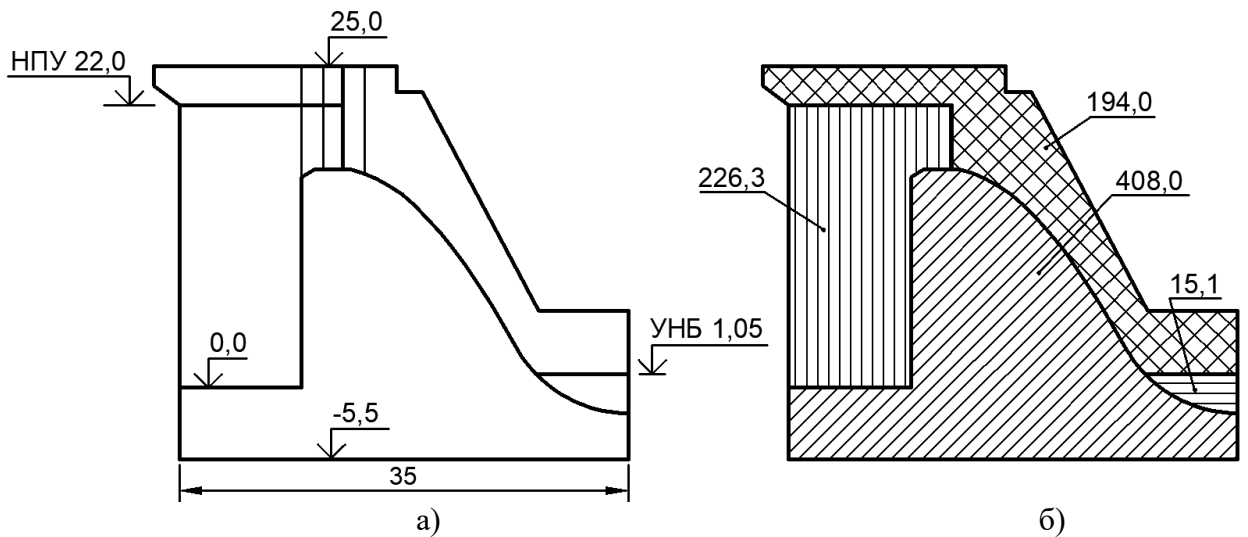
Исходные данные к расчёту нагрузок на бетонную водосливную плотину
